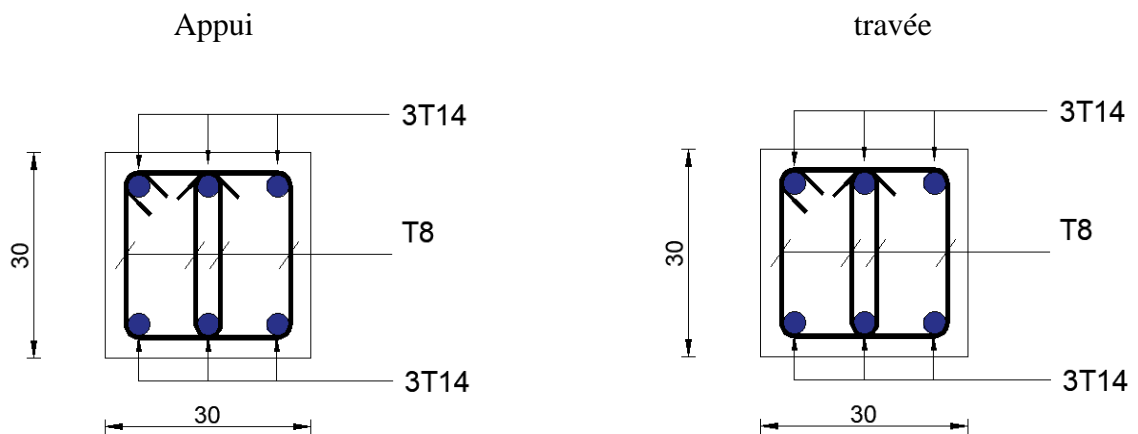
schéma de ferraillages des poutres de chainages (9^{ème} étage---RDC)
